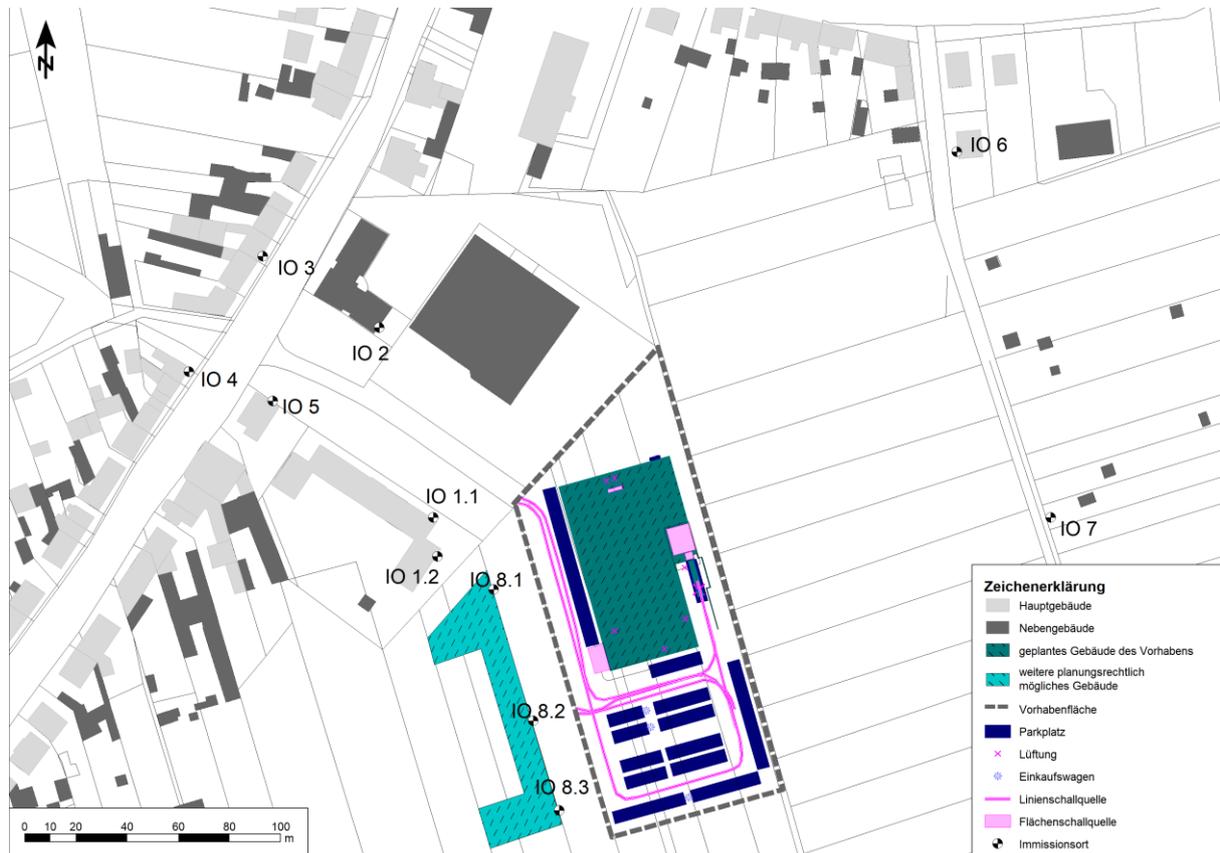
Lageplan der berücksichtigten Immissionsorte außerhalb des Plangebiets
